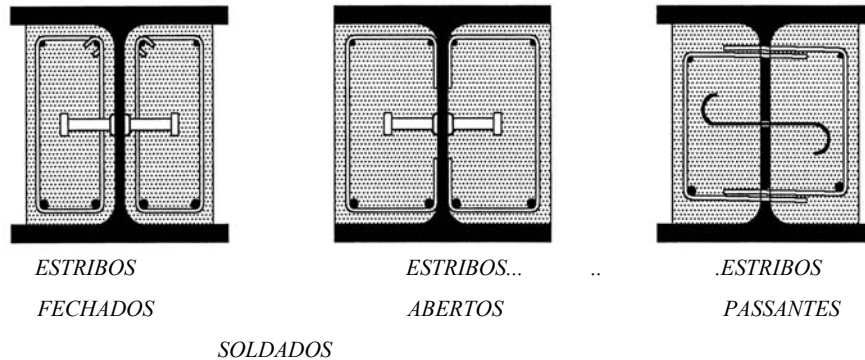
Armadura transversal na alma do pilar misto. EC-4,2000
